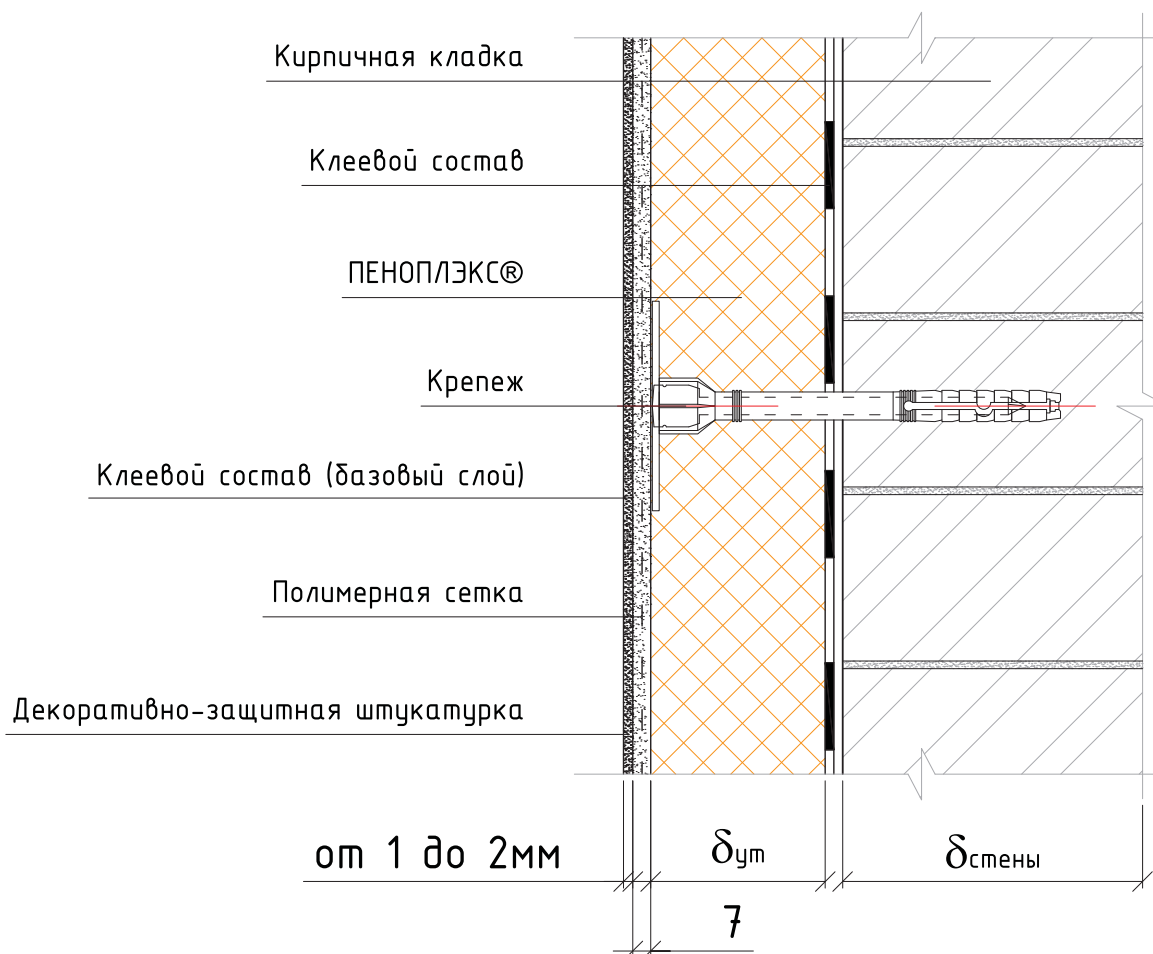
Схема конструкции стены первого или цокольного этажа №2
